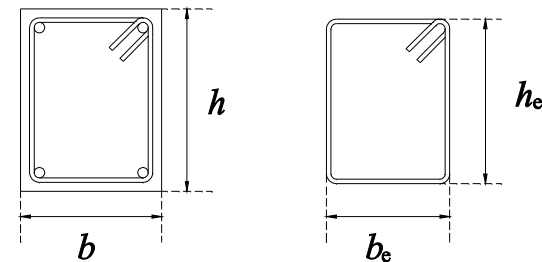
Tolerancias para columnas en la dirección del refuerzo principal.
